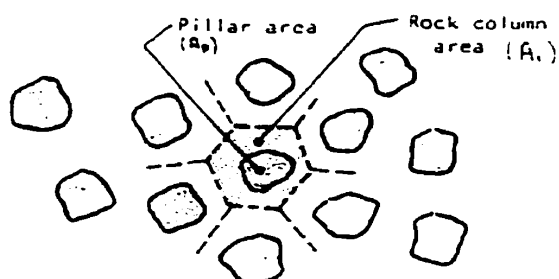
Piliers irréguliers à section droite plus ou moins circulaire montrés en plan, [Hoek & Brown, Underground Excavation in Rock, 1980].
